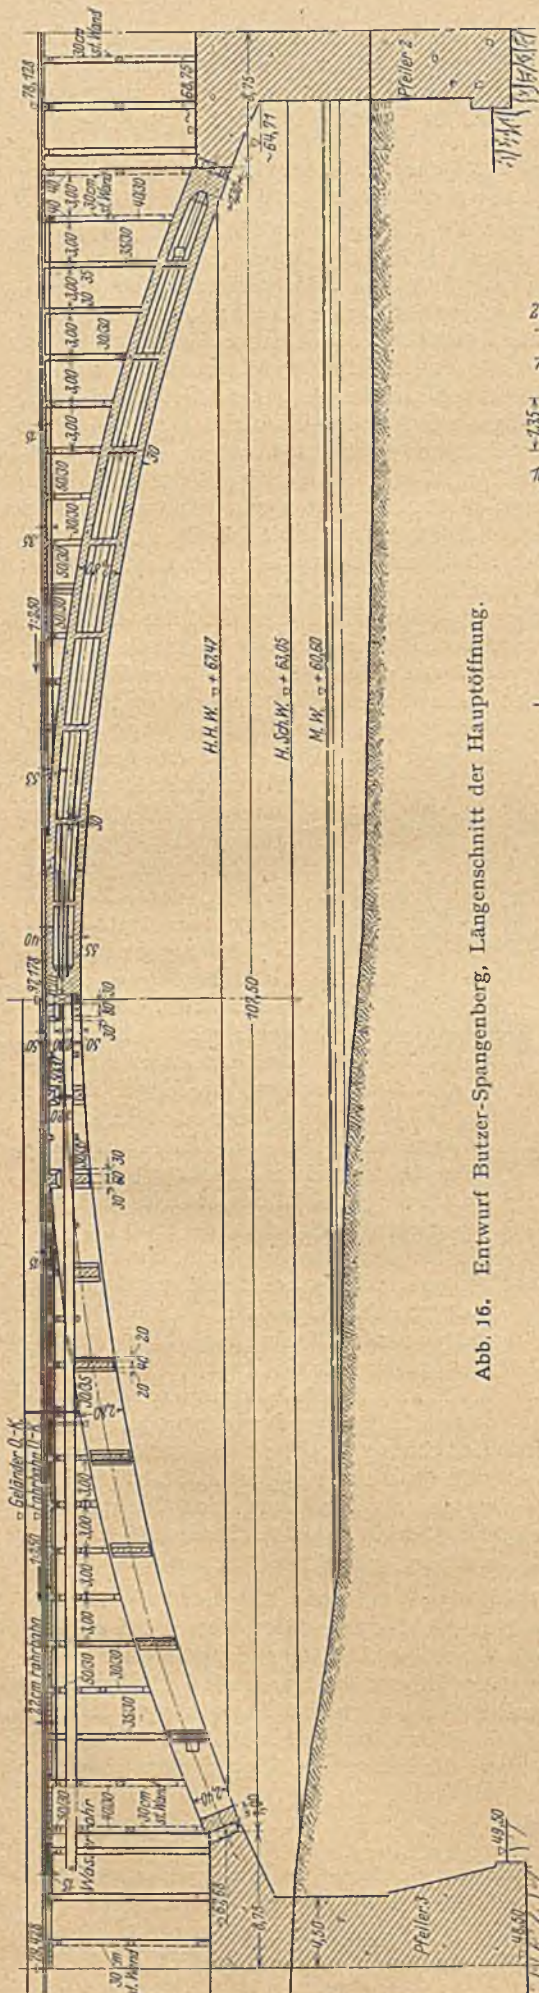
Entwurf Butzer-Spangenberg, Längenschnitt der Hauptöffnung.
